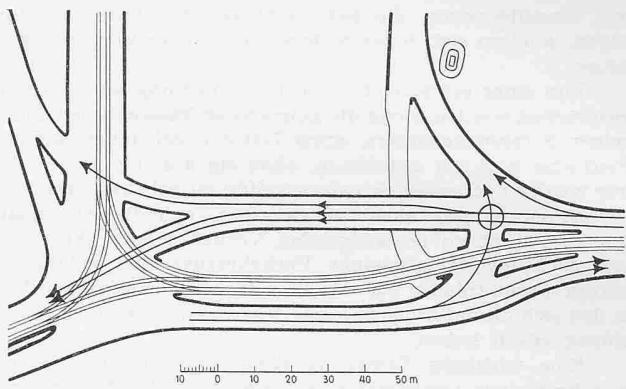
Variante zu Bild 14, Maßstab 1:2000. Der Verkehr aus dem Stadthausviertel nach dem rechten Limmatufer wird über Börsestrasse und Bahnhofstrasse umgeleitet gemäss Bild 13b. Damit entfällt jede Störung des von der Brücke kommenden Fahrverkehrs durch Querverkehr von der Fraumünsterstrasse und es bleiben nur die verhältnismässig seltenen Querfahrten ortskundiger Fahrzeugführer vom Alpenquai nach der Fraumünsterstrasse und ein einziger, dementsprechend schwach belasteter Schnittpunkt feindlicher Verkehrsströme (im Kreis). Uebrige Vorteile siehe Bild 11d. Durch eine solche Verkehrsführung erhält der Bürkliplatz bei im wesentlichen unveränderter baulicher Gestalt ein Höchstmaass an Leistungsfähigkeit für den Strassenbahnbetrieb wie für die allgemeine Verkehrsabwicklung, womit sich der geringe Nachteil der Umleitung eines verhältnismässig bescheidenen Lokalverkehrs bezahlt machen dürfte
